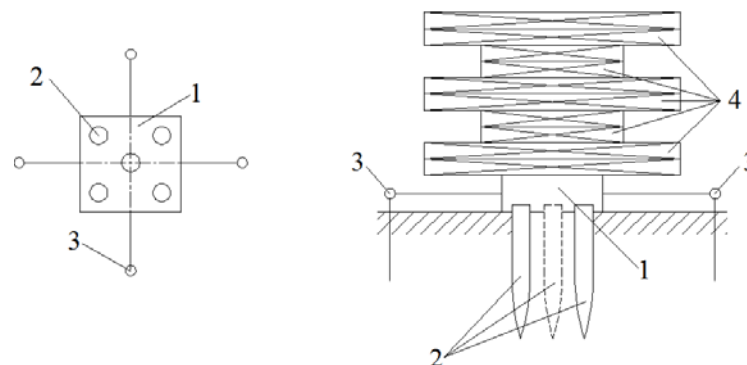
Схемы фрагментов отдельно стоящих и плитных фундаментов из НРСн, объединяющих 4 (а) или 5 (б) свай для проведения статических штамповых испытаний: 1- фрагмент; 2- НРСн; 3- измеритель осадки фрагмента; 4- грузы с известной массой.
